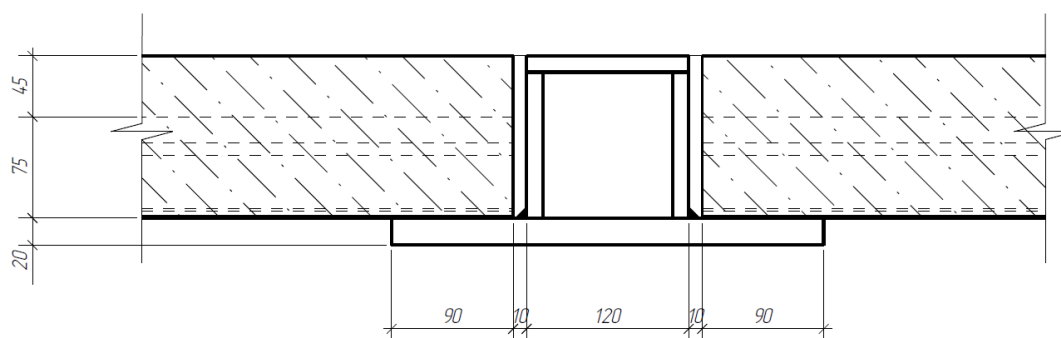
Схема опирания сталежелезобетонного перекрытия на стальную балку
